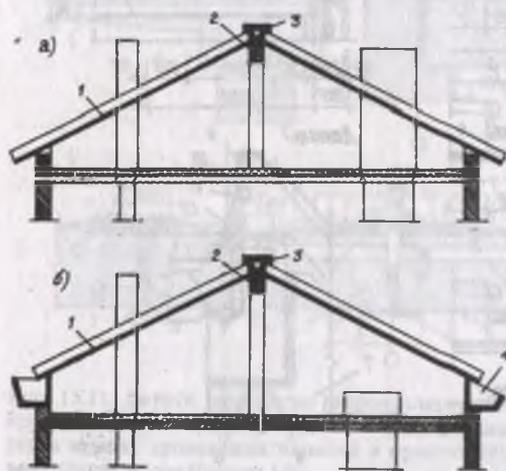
Сборные железобетонные конструкции крыш с холодным чердаком:
